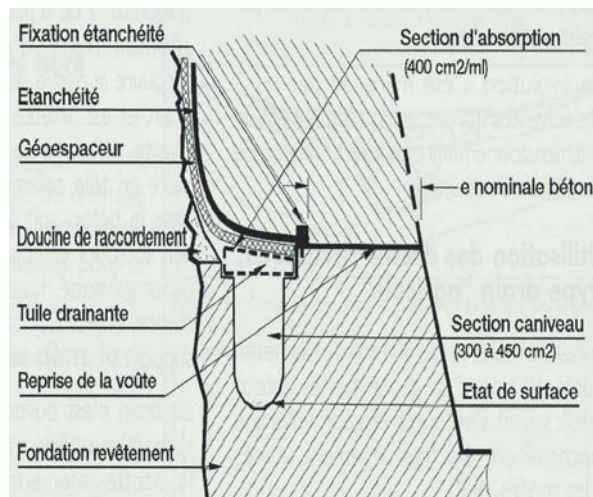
Exemple de dispositif de drainage intégré à la banquette d'un tunnel
